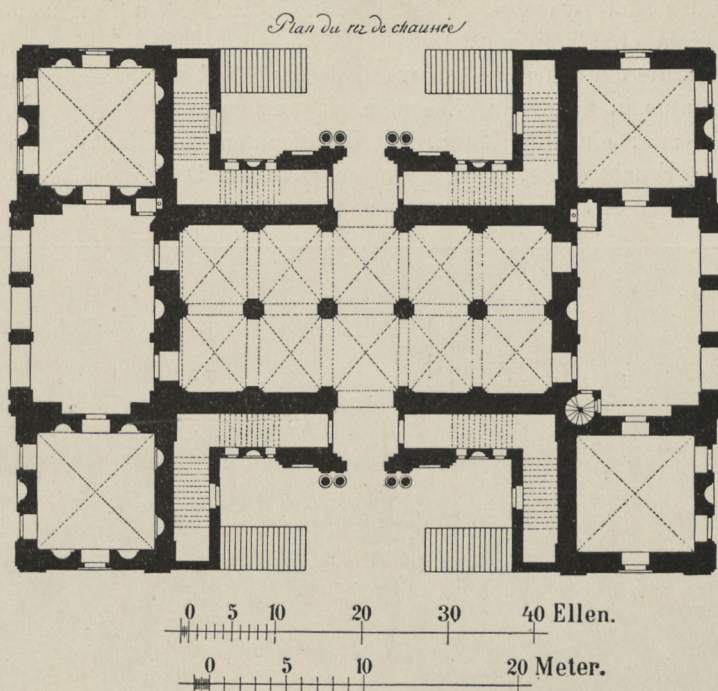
Palais im Grossen Garten. Grundriss des Erdgeschosses.
